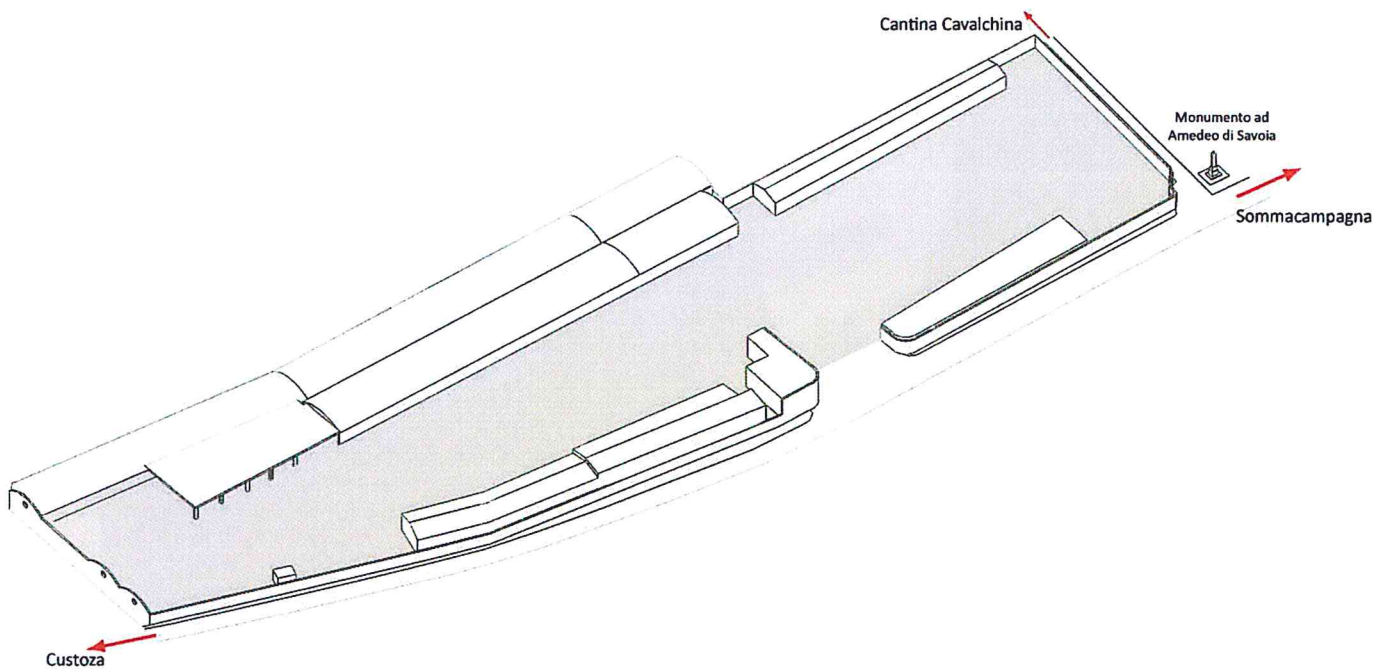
Stato di fatto. Vista assometrica dell'area di intervento.
